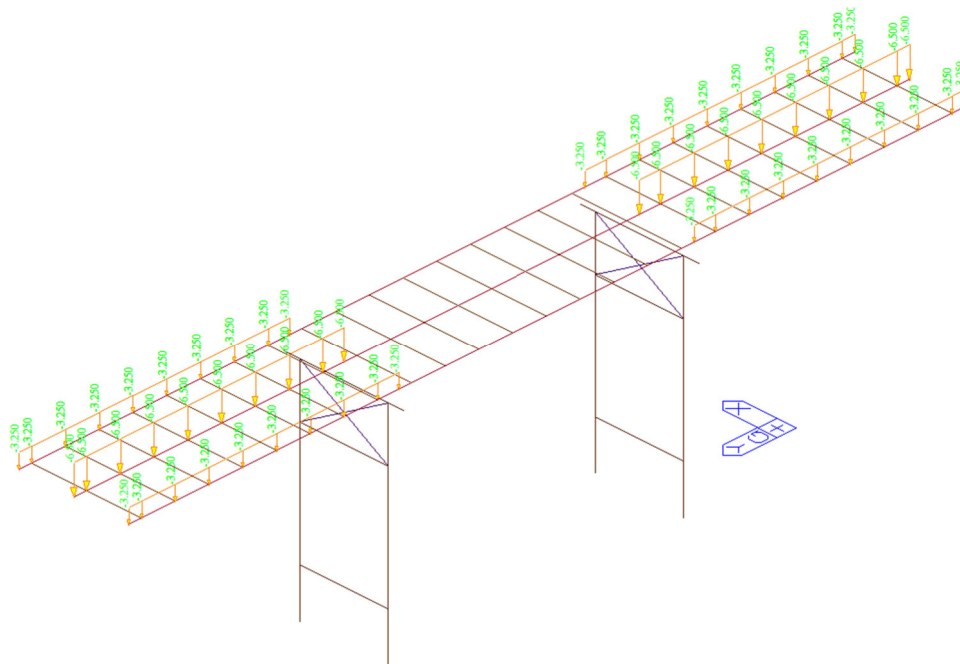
g2 parapetto 0.4 kN/m su travi bordo [kN/m]
